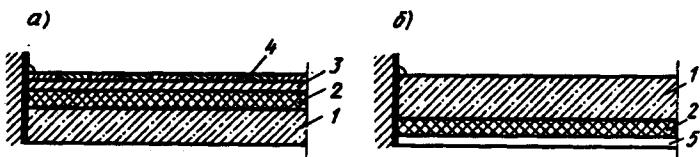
Утепление перекрытия плитами из пенопласта
